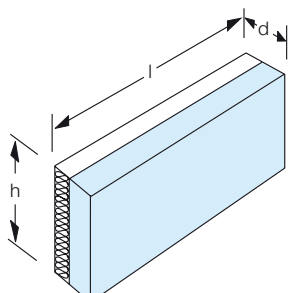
Porenbeton-Höhenausgleichsteine
